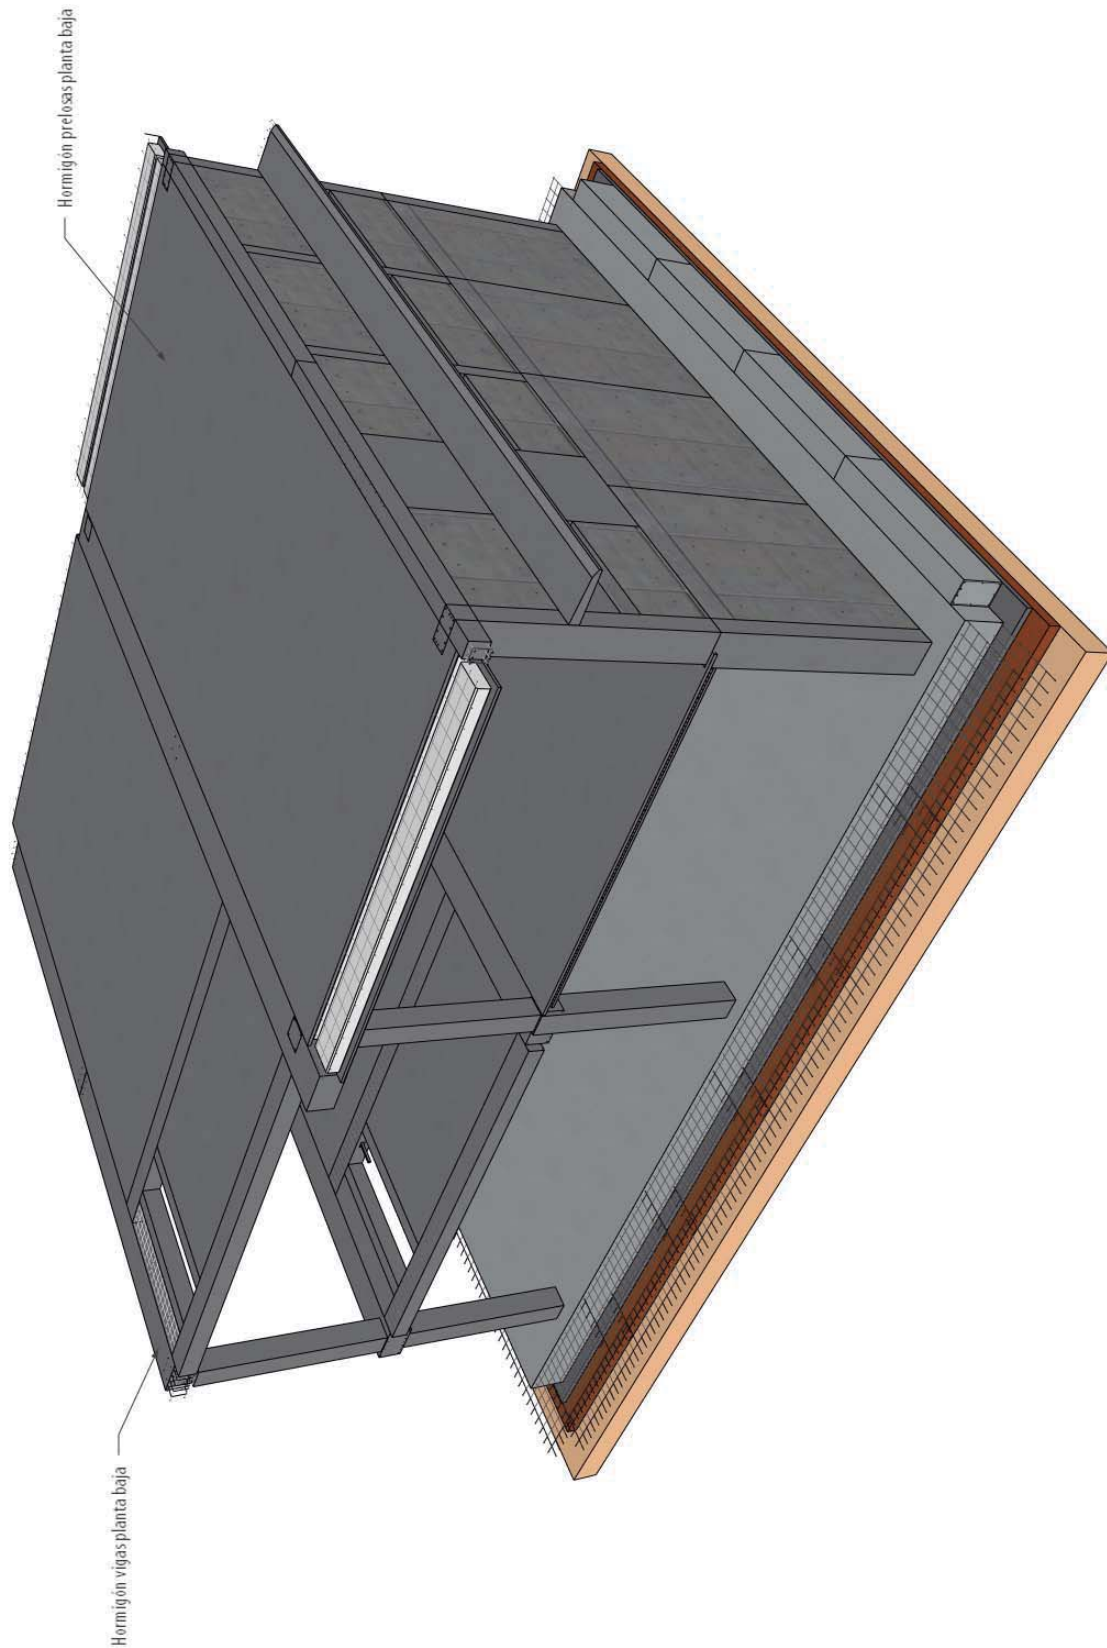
Hormigonado de las prelosas del forjado de la planta baja
